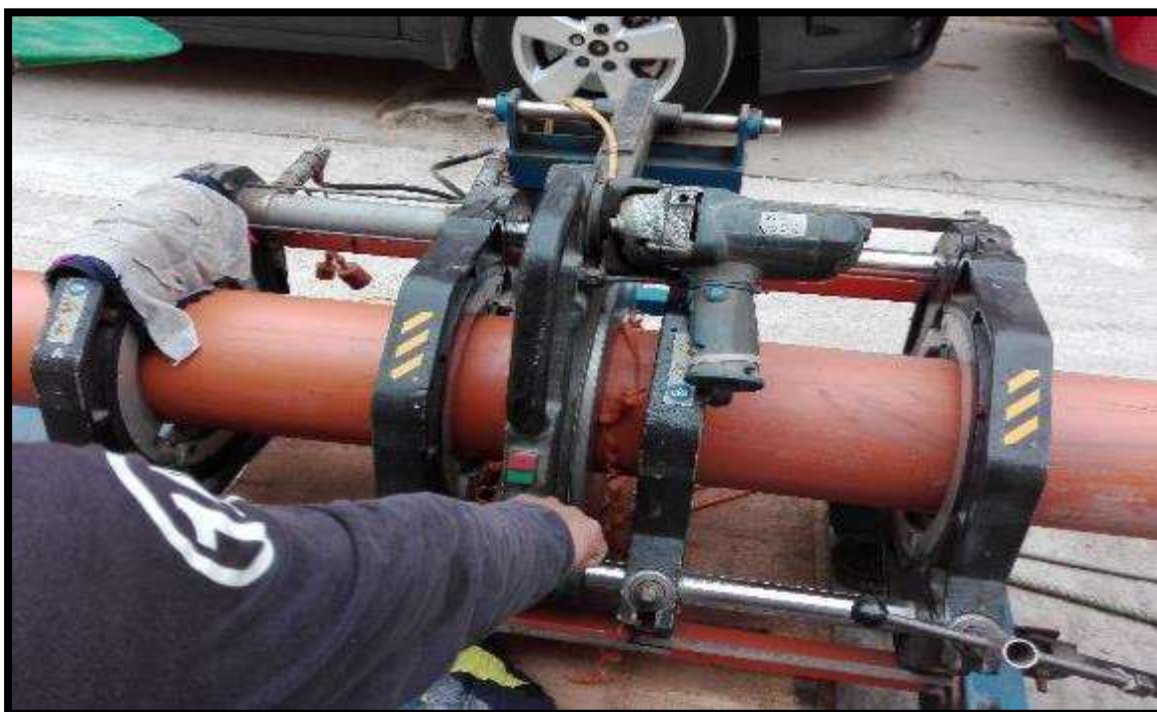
Alineamiento de la tubería de 200mm HDPE para la unión por termo-fusión.
